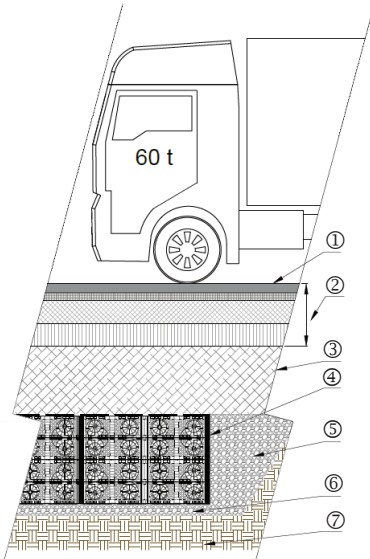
Einbau unter befahrenen Verkehrsflächen bis SLW60
